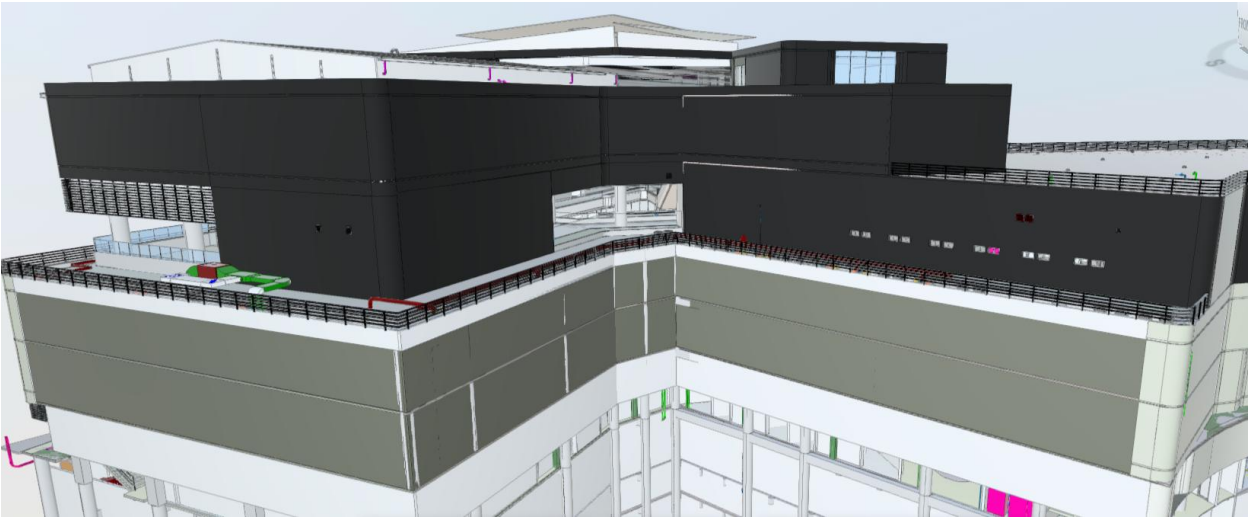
Render C.C. Plaza Videre - Vista 19 Avenida / boulevard Vista Hermosa
